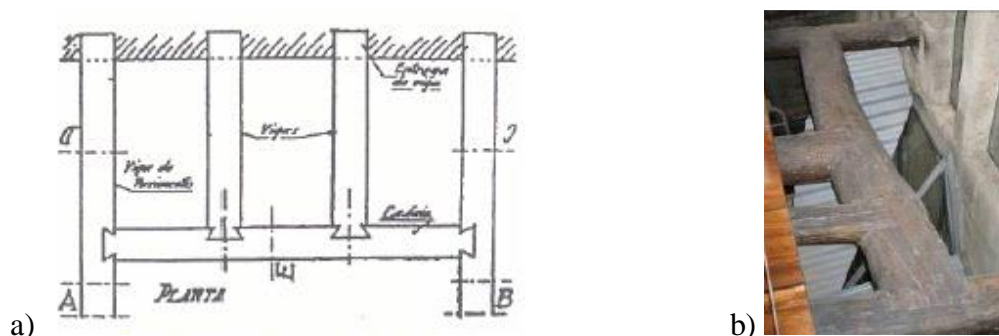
Cadeia: a) configuração (Ilharco, 2008) ; b) Ilustração num pavimento na casa do Infante, Porto (Ilharco, 2008).
